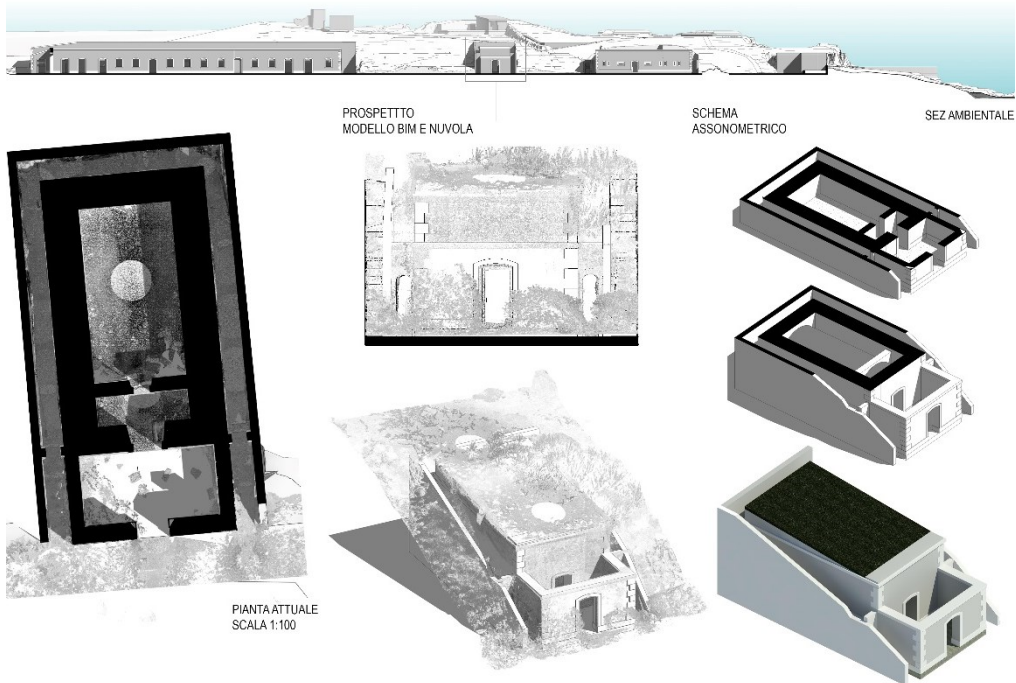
Scheda di analisi 2. Ex Deposito munizioni: pianta, prospetto e spaccati assonometrici
